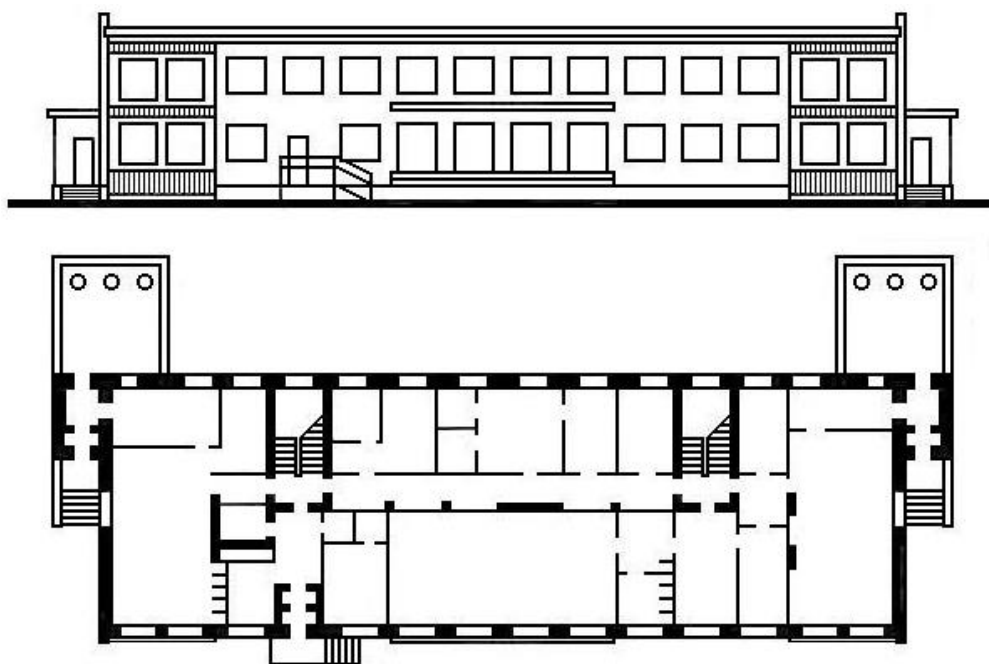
Белгоспроект. Серия Б2-02. Типовой проект детсада-яслей на 140 мест, примененный для строительства в микрорайоне № 1. Схема фасада и плана первого этажа
